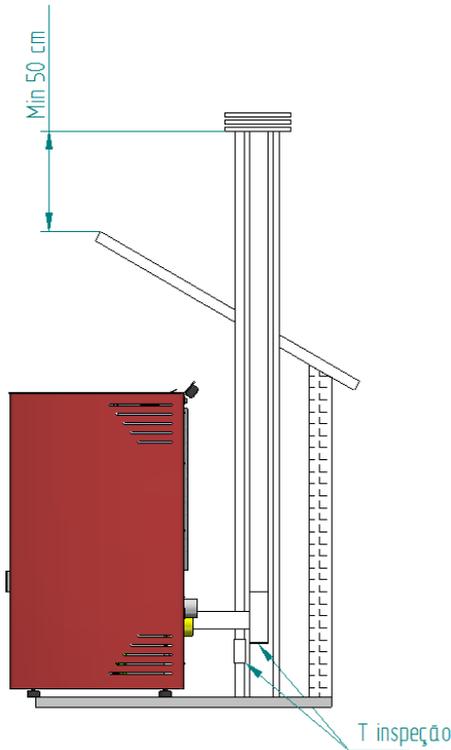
Vista lateral de la instalación con chimenea, con ejemplo del punto de inspección.
